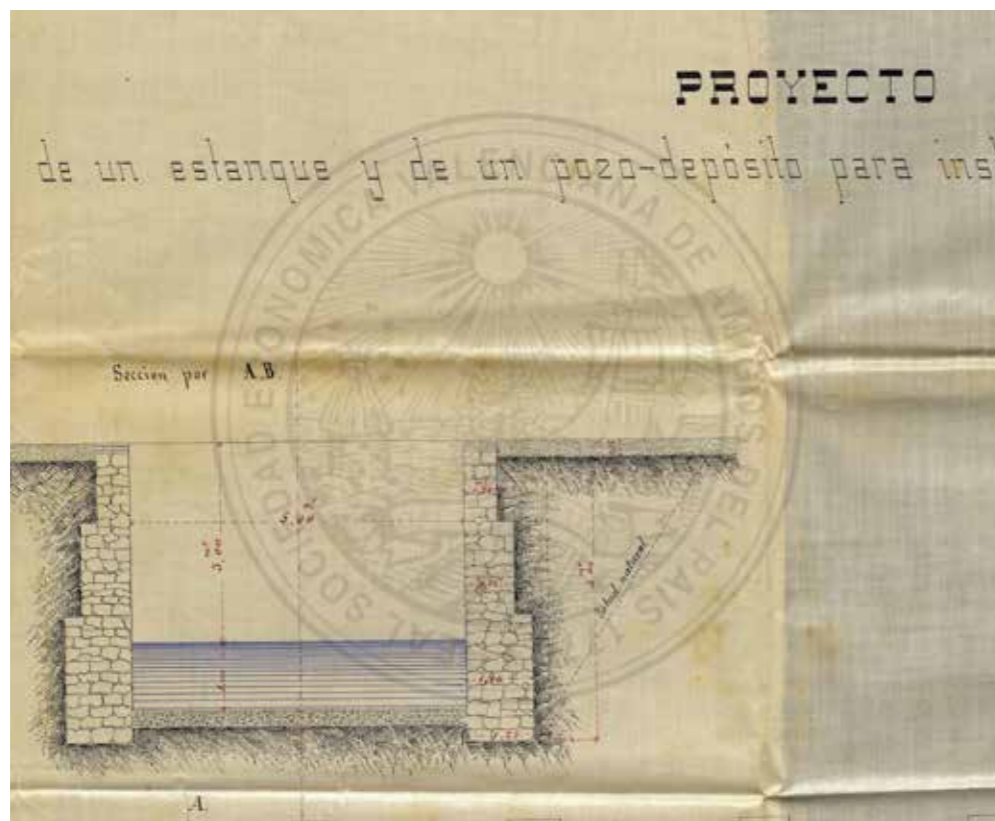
Proyecto constructivo del Estanque. Archivo de la RSEAPV
